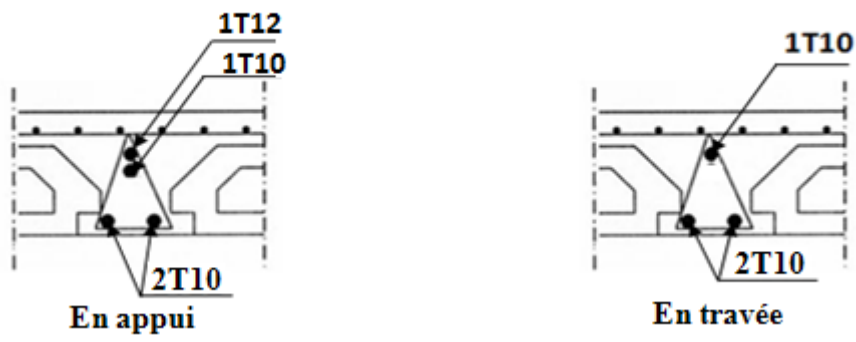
disposition des armatures dans la poutrelle (appuis et travée)
